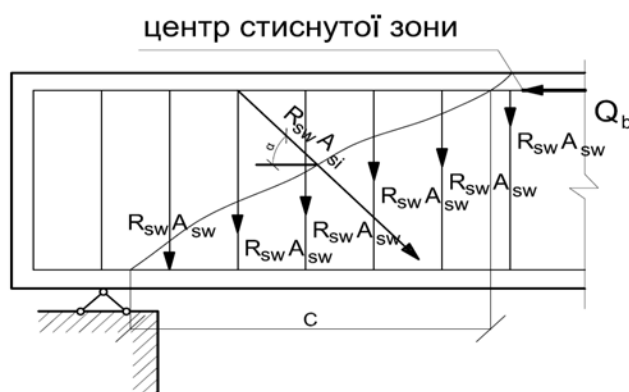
Схема зусиль у перерізі, нахилому до поздовжньої осі залізобетонного елемента з ненапруженої арматурою, при розрахунку його міцності на дію поперечної сили
